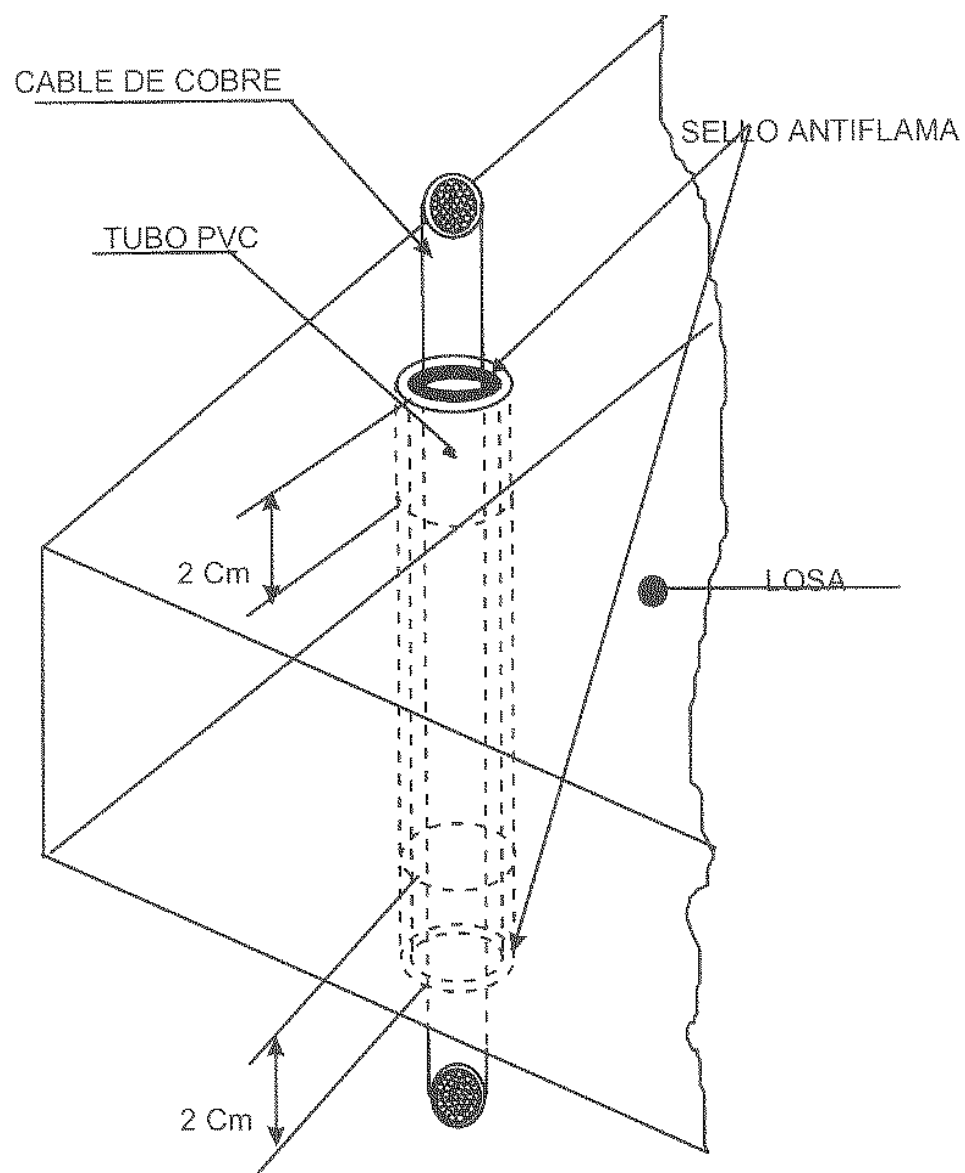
Paso de Cable por Losa Mediante Tubo Conduit de PVC.
